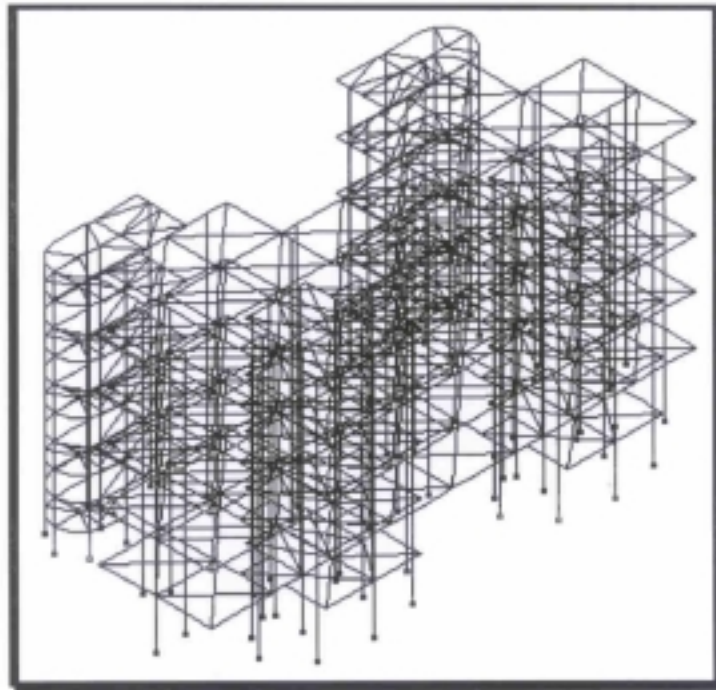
Edificio de mampostería de cinco niveles, modelo de la columna ancha y vista panorámica
